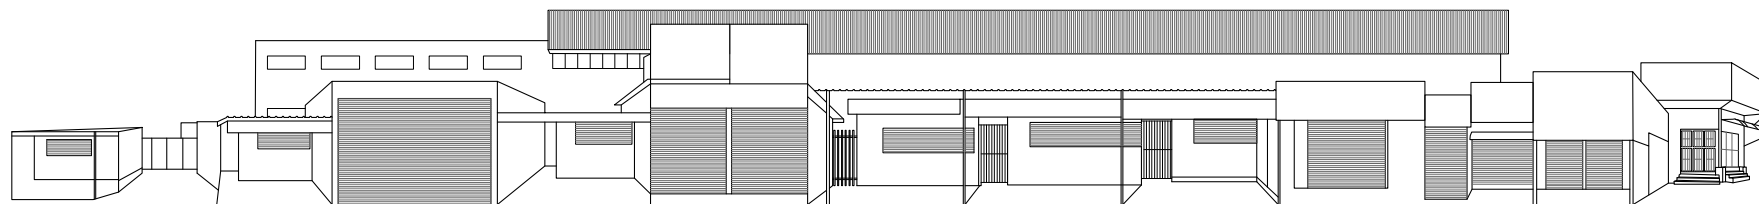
Fachada Sul. Fonte: produzido pela autora, 2018.
